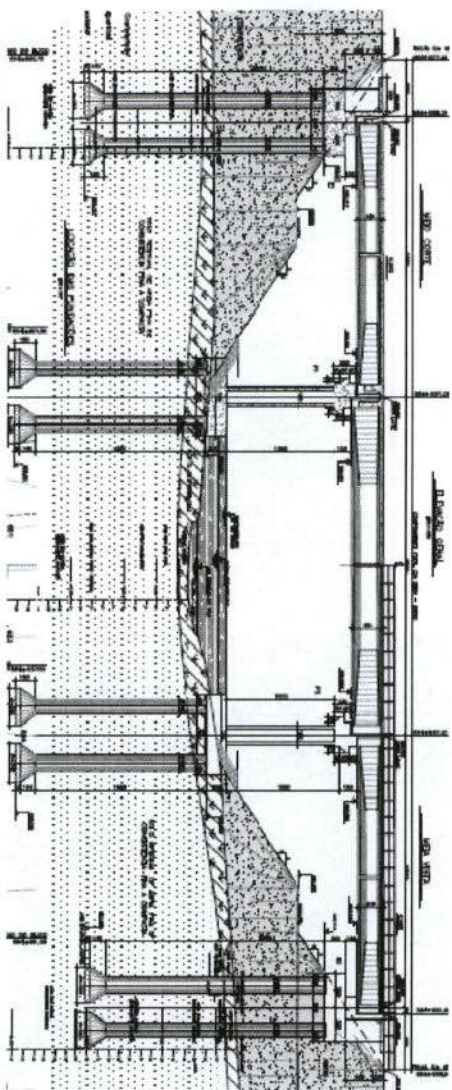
Projeto da ponte sobre o Rio Galheirão (elevação em corte)
